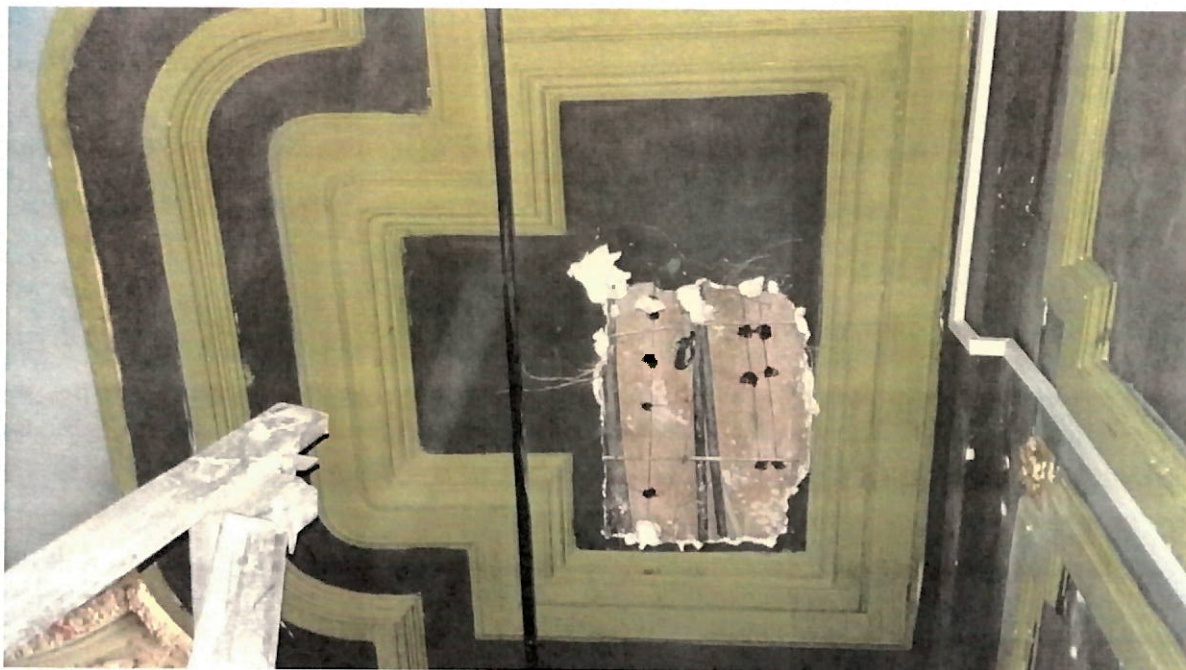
planseu consola interioara balcon in etaj 1 (sala teatru)
